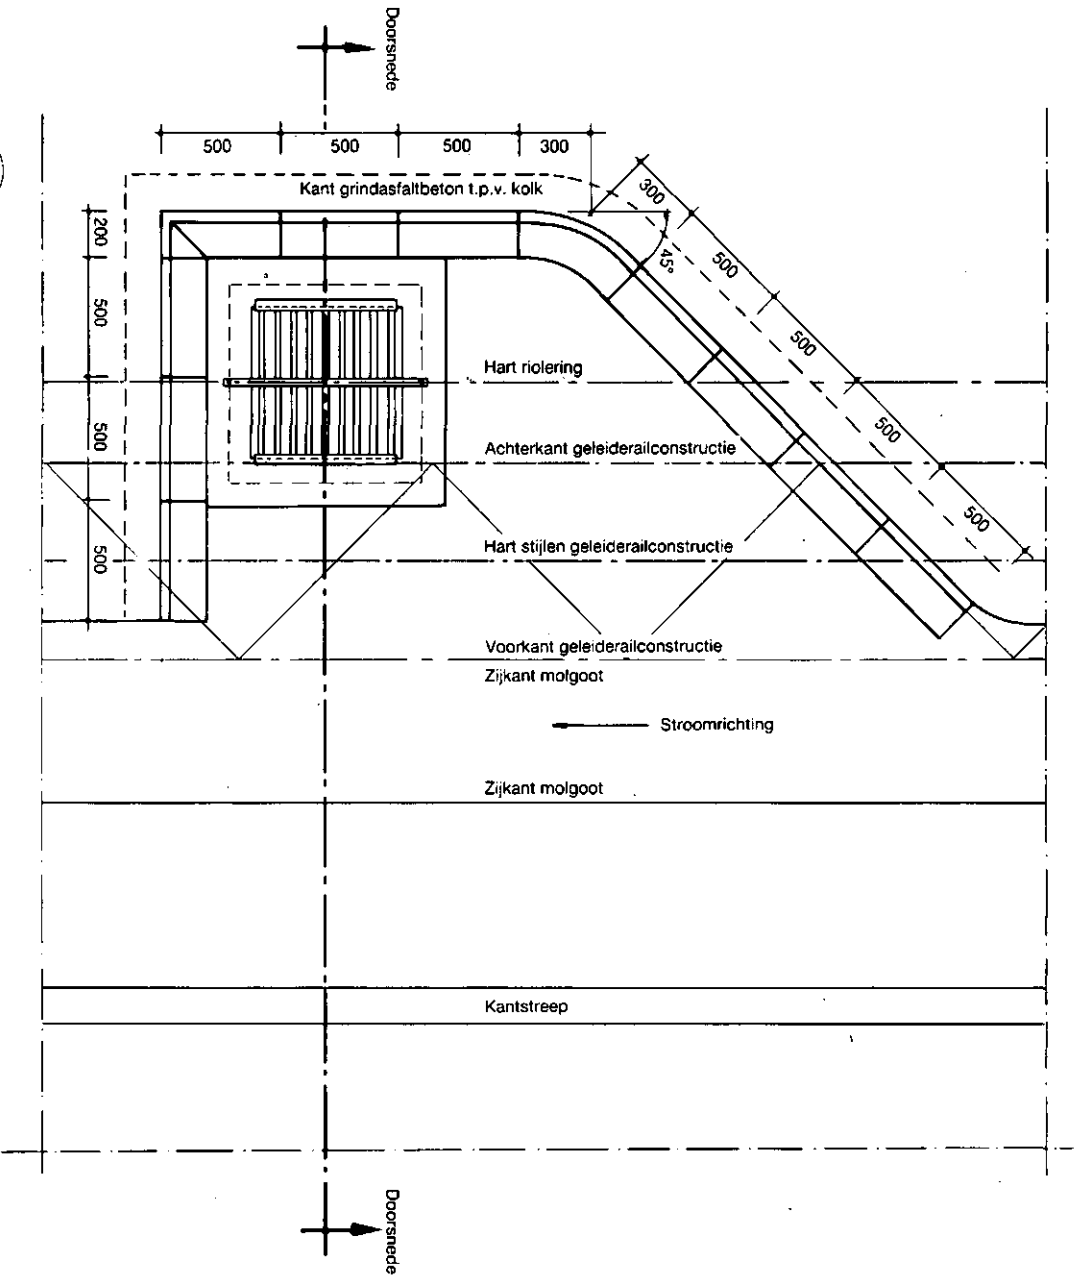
Situering asfaltbetongoot ter plaatse van zijberm.
